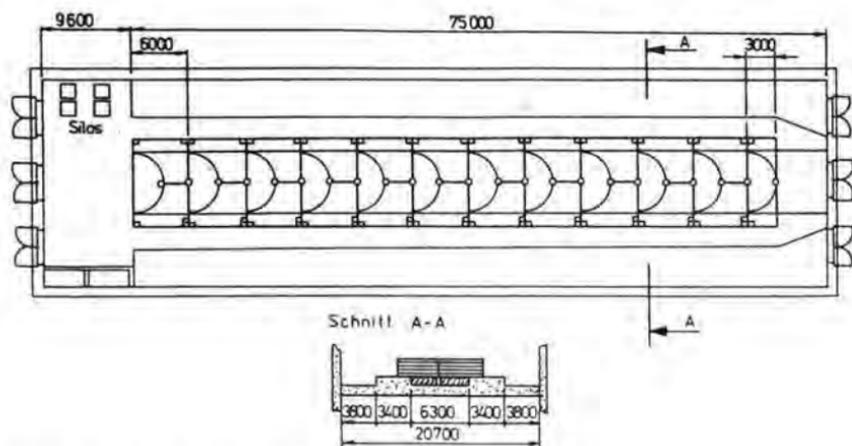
Kompoststall in Schwanebeck - 1. Stufe: 550 Mastschweine.
